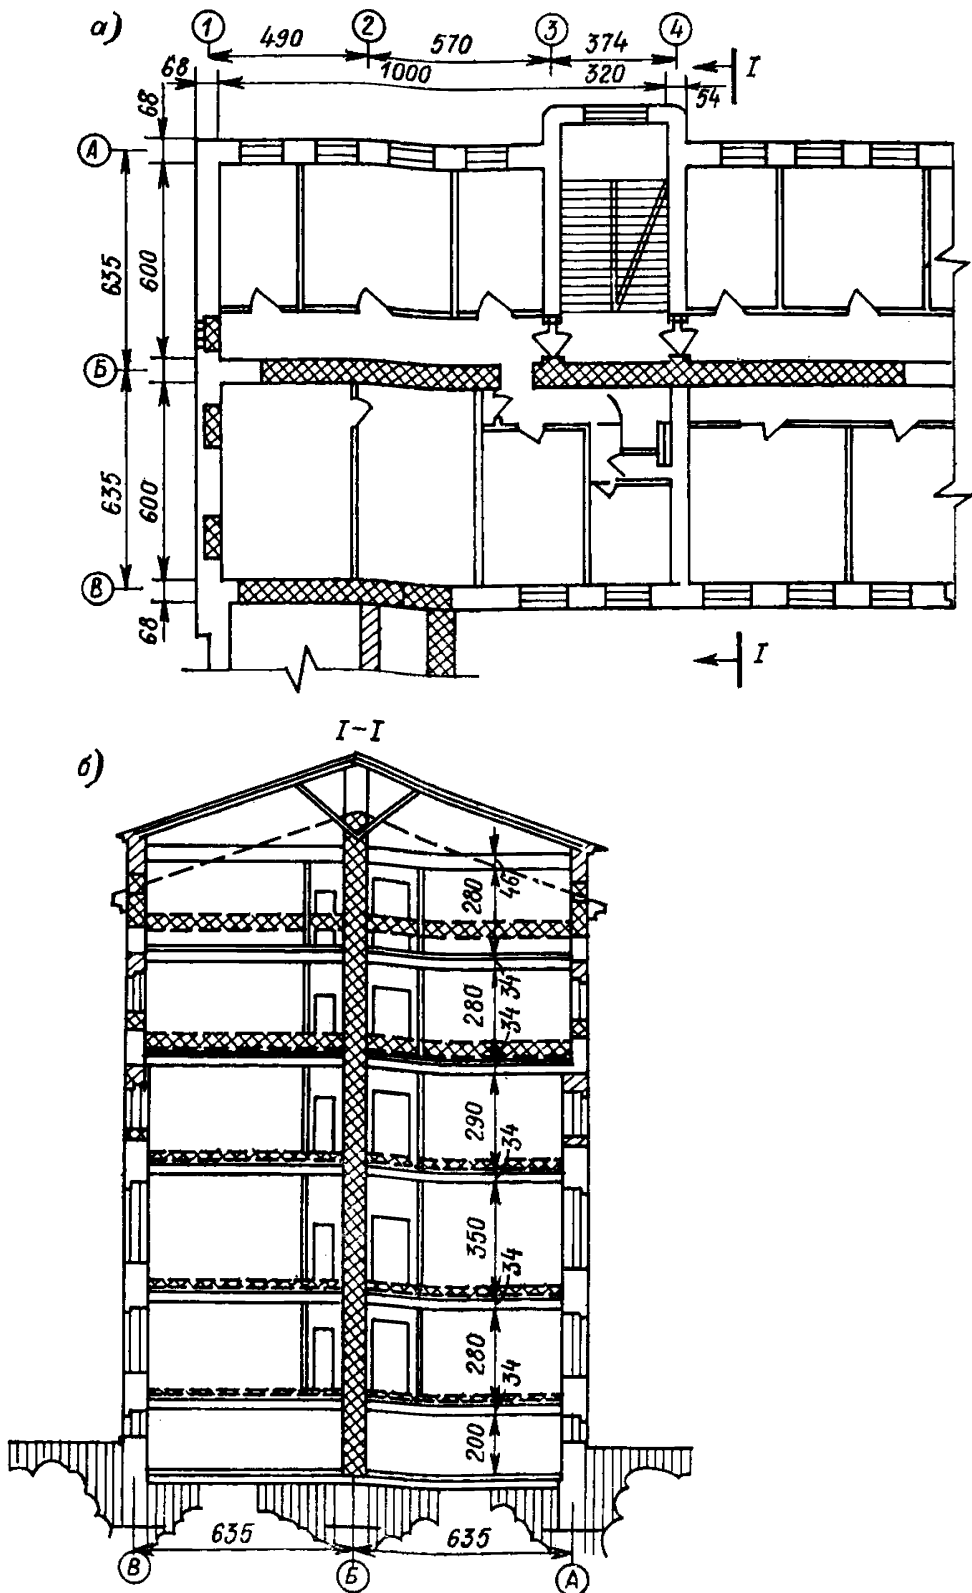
Пример проектного решения по перекладке участка средней продольной стены при комплексном капитальном ремонте жилого дома
